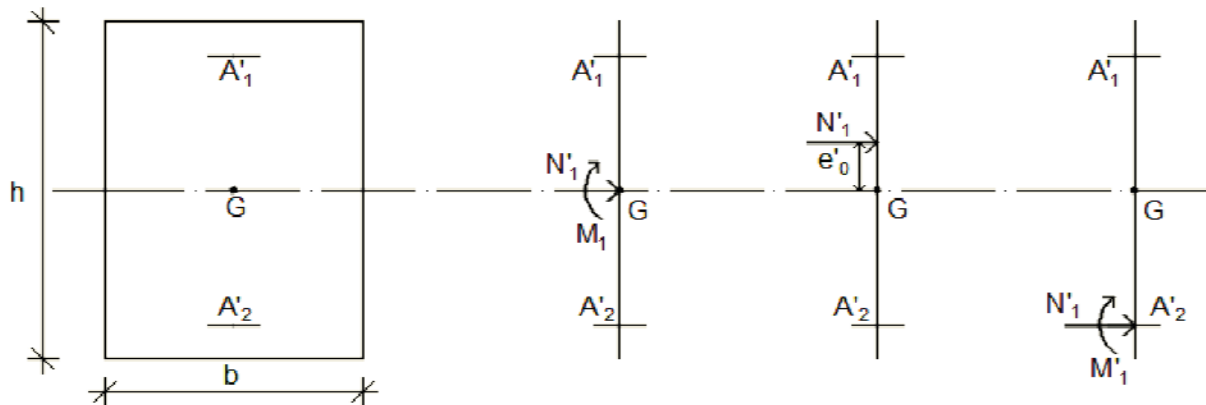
Position de N'_1 , M'_1 et M_1 sur la section transversale.
